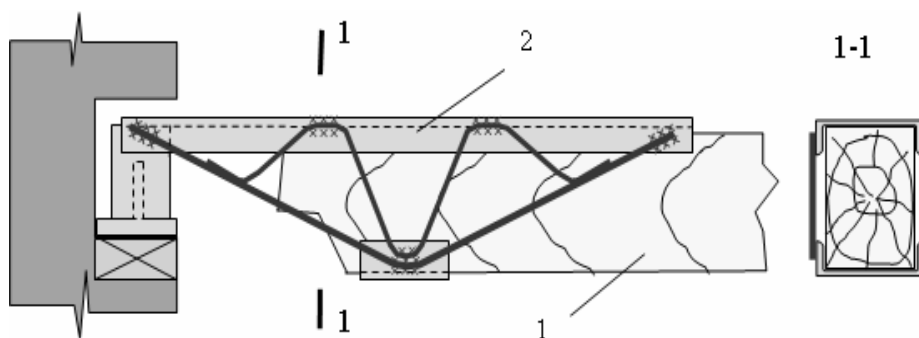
Усиление опорных участков стержневыми накладками:
